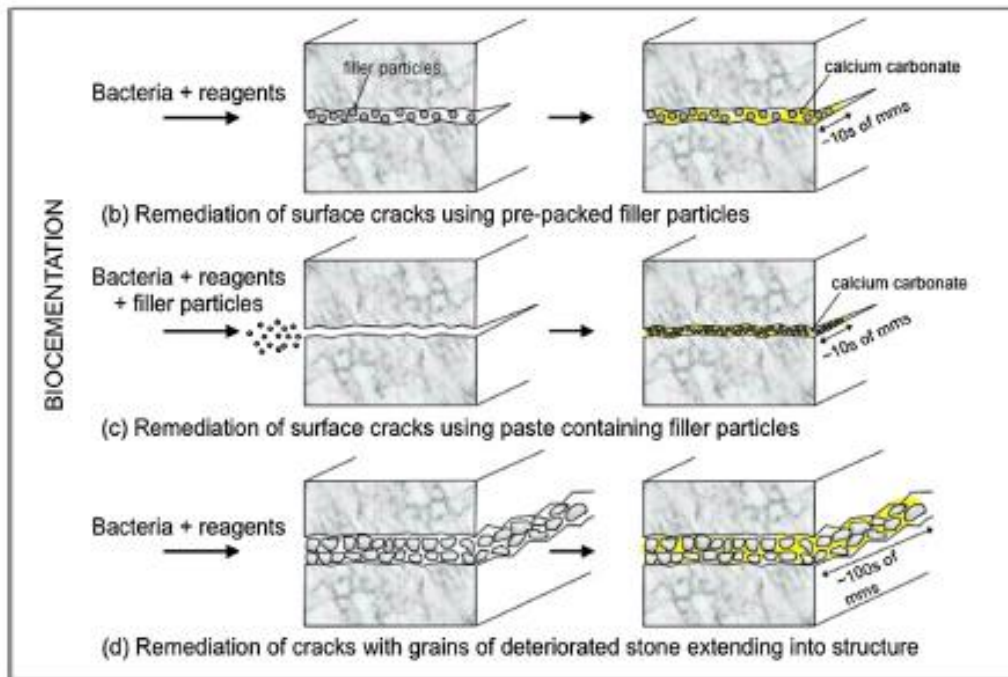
(b) Remediação de fissuras superficiais usando partículas de enchimento, (c) remediação de fissuras superficiais usando pasta com partículas de enchimento e (d) remediação de fissuras com grãos de pedra deteriorada (Minto *et al.*, 2018).
